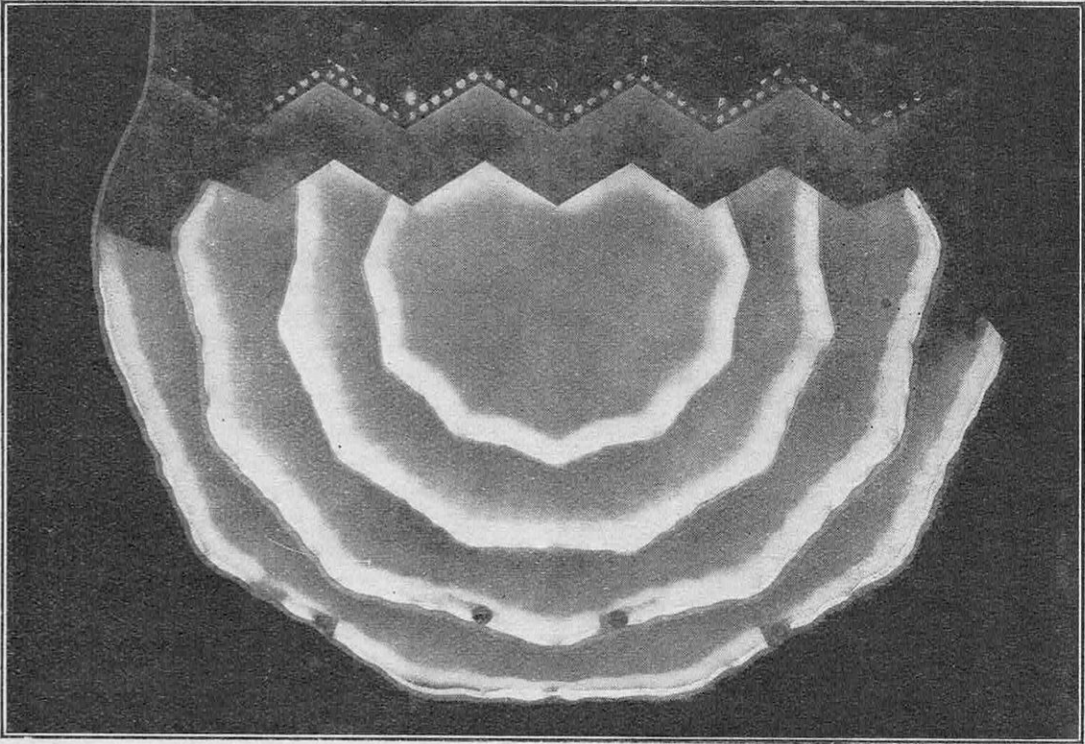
VUE DU PLAFOND LUMINEUX DE LA SALLE DU THÉÂTRE PIGALLE
